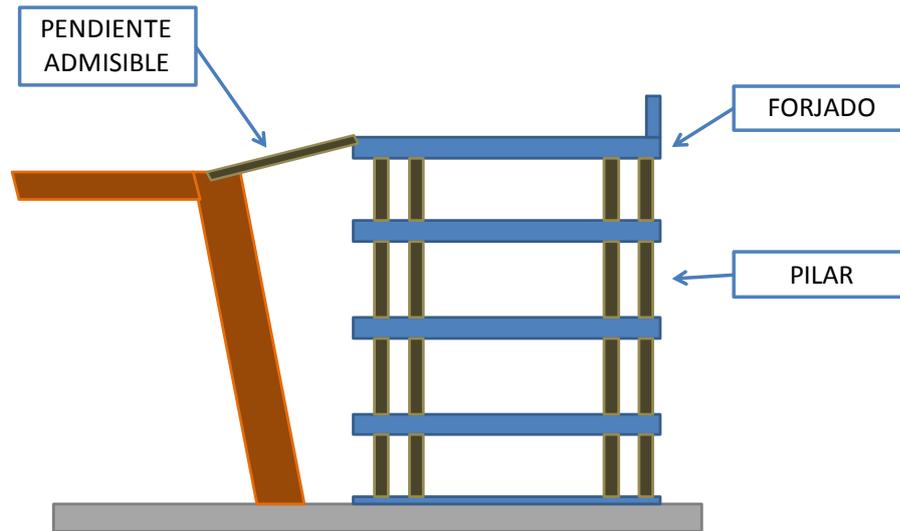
Croquis de la solución propuesta pilar + forjado (Elaboración propia)
